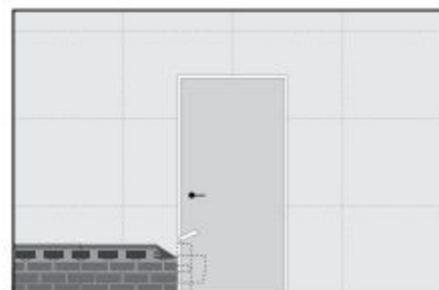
Монтаж фасадной плитки вокруг дверных проемов
